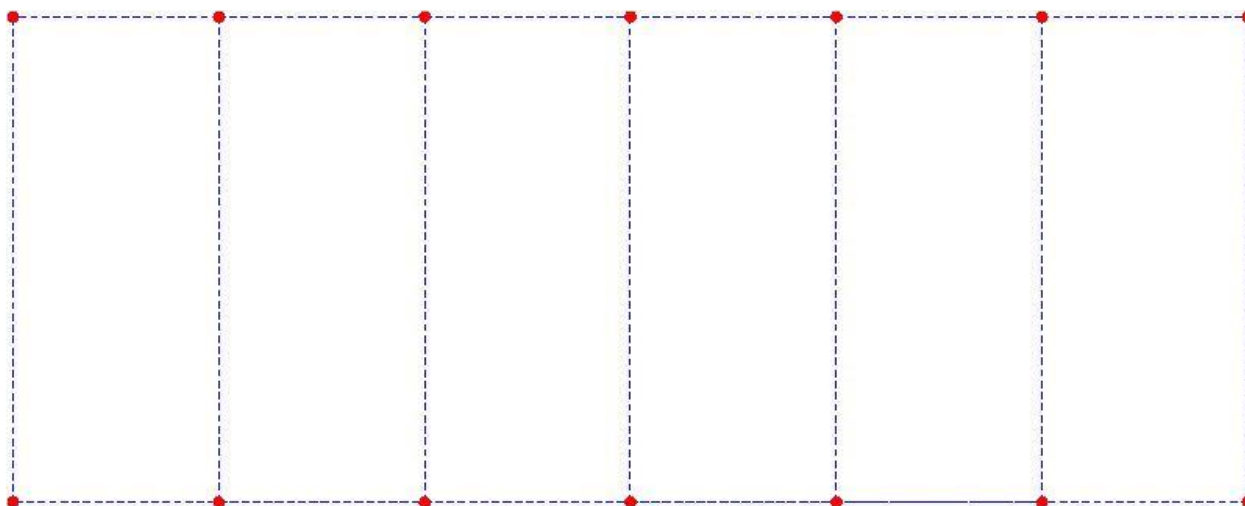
Ex Galoppatoio – pianta delle fondazioni Fabbricato 1
